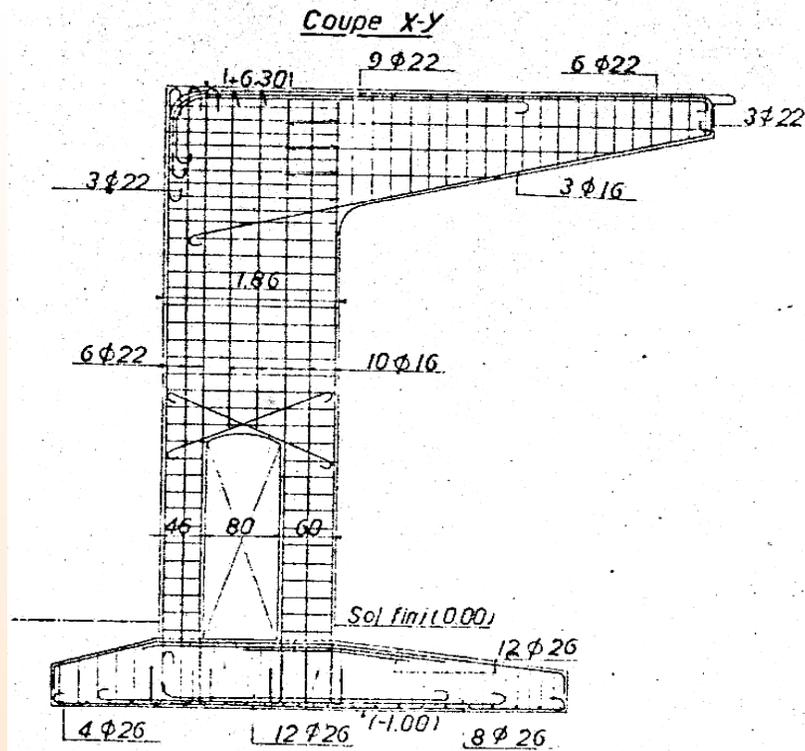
Elevation et coupe d'un demi-arc.* 45
